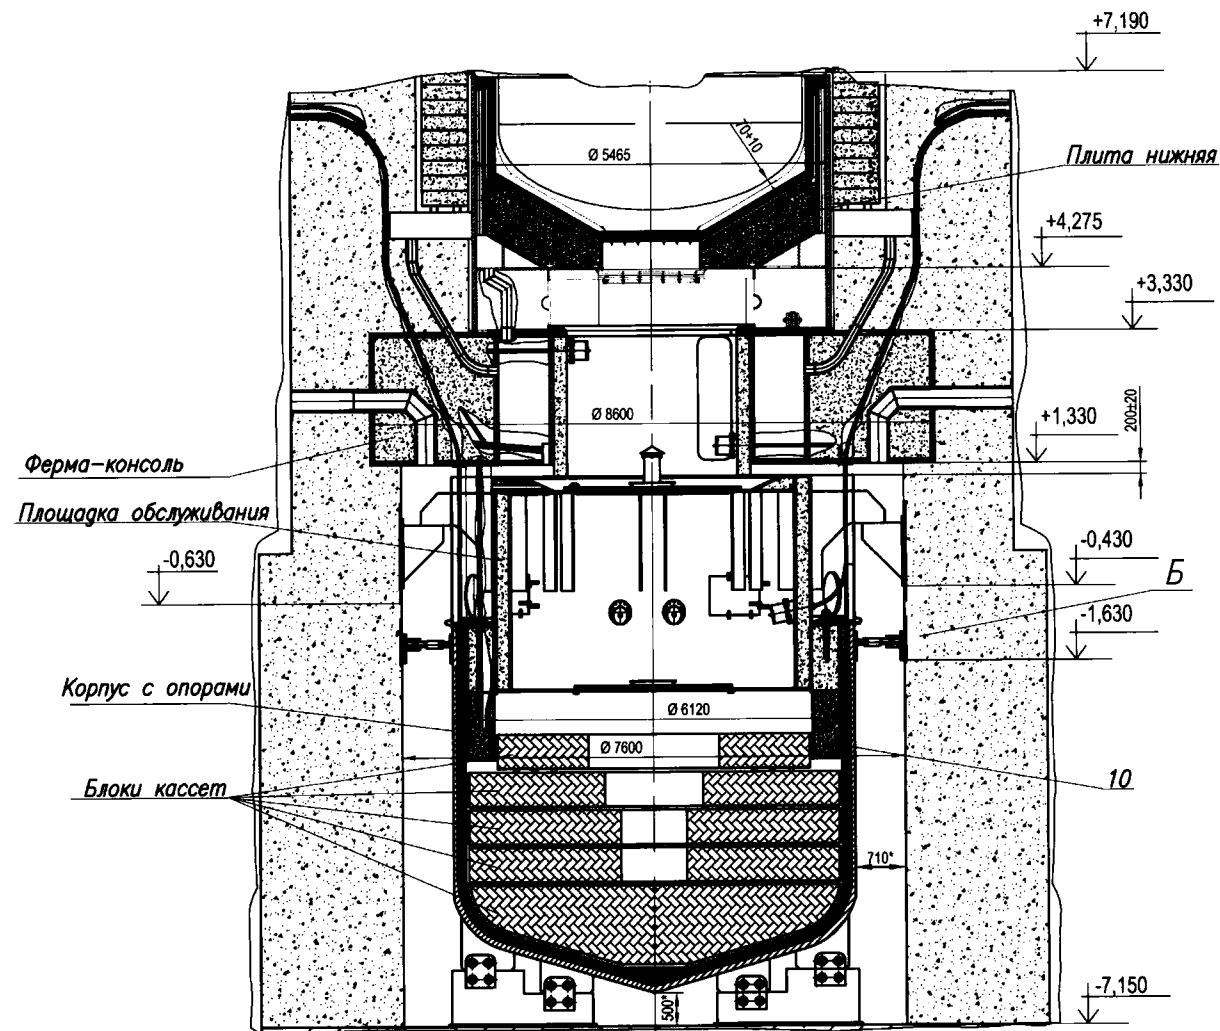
Габаритный чертеж устройства локализации расплава
